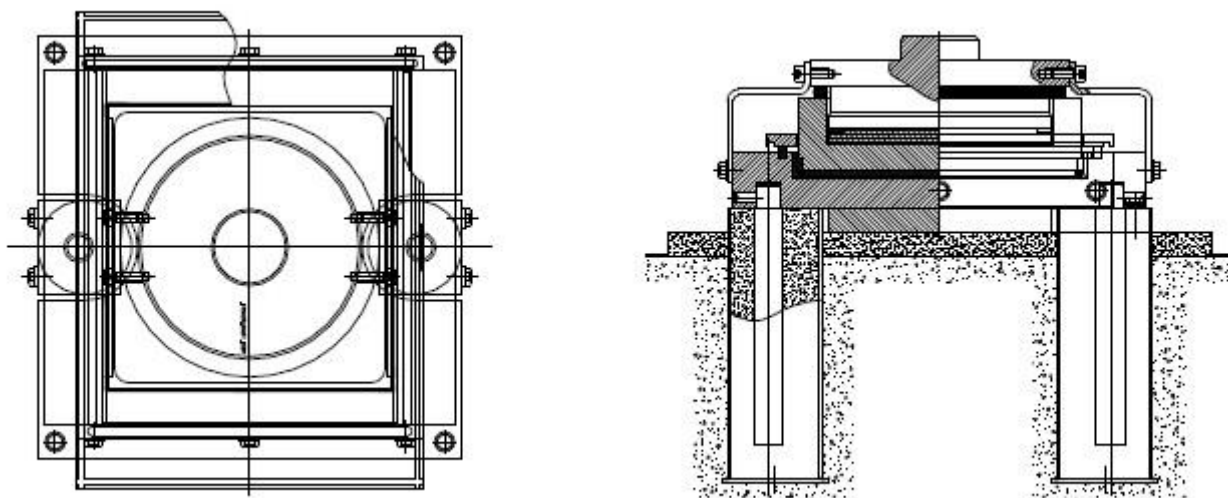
1 Appoggio Unidirezionale a disco elastomerico confinato
